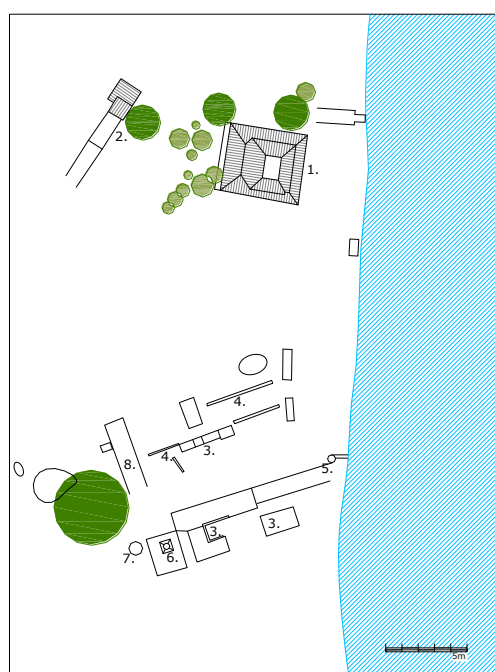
Planta del conjunto arquitectónico de la Charqueada São João.
